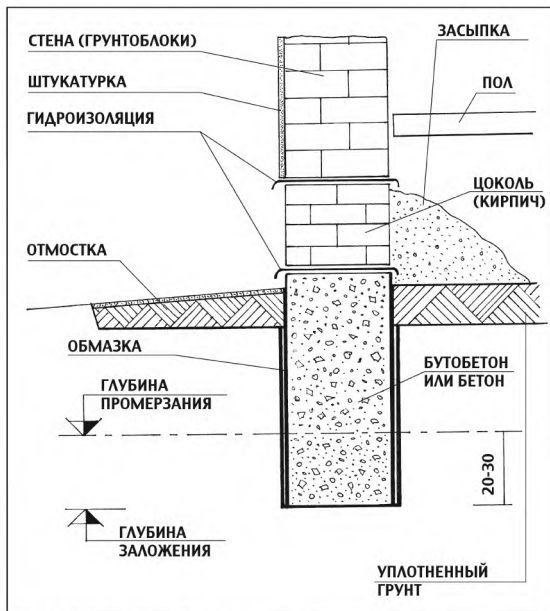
Устройство фундамента и нижнего пояса стены (цоколя).
